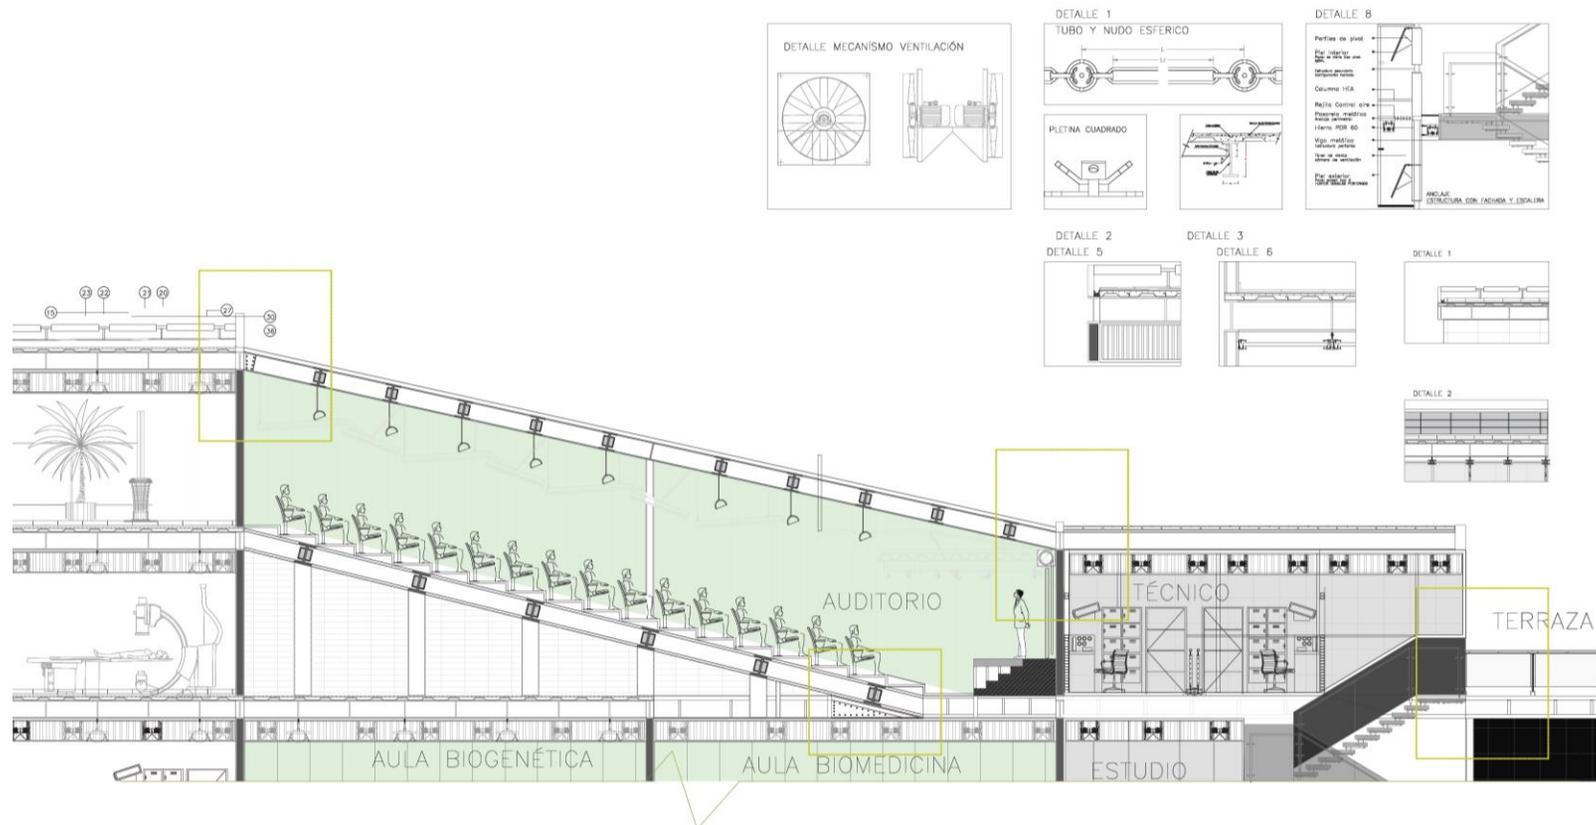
Corte fachada 4 detalle auditorio y cubierta
